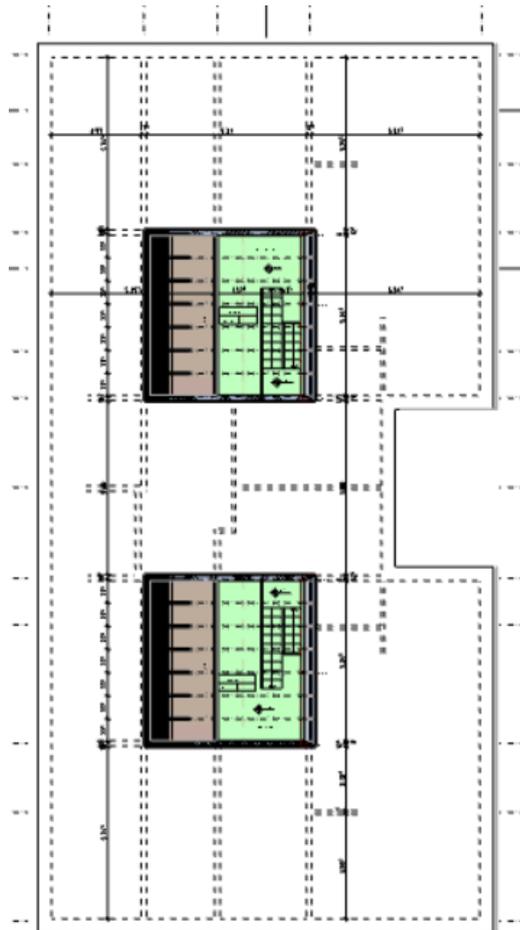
Grundriss Obergeschoss, zoniert
